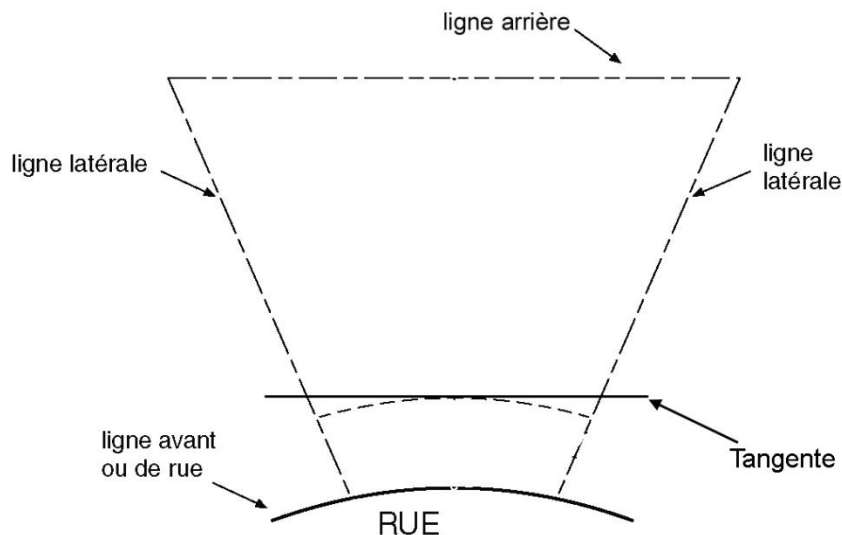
Alignement de la façade avant sur un terrain à l'extérieur d'une courbe
